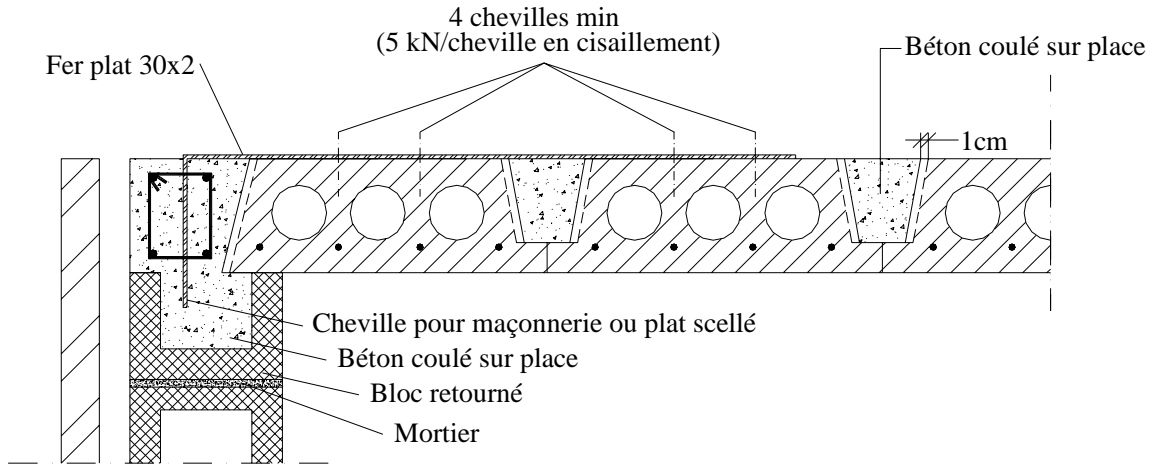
Liaison entre plancher en éléments de béton préfabriqué et mur, en tête de mur. Appui direct des éléments préfabriqués. Pas de chape armée.
